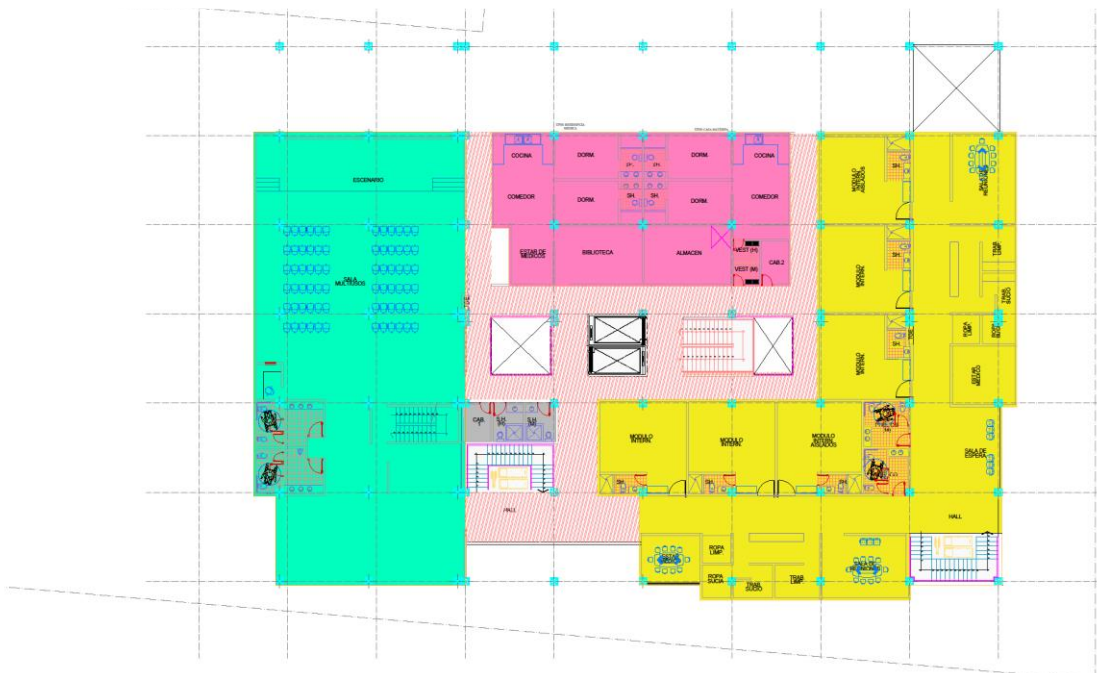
Planta arquitectónica de la edificación, nivel 04.
